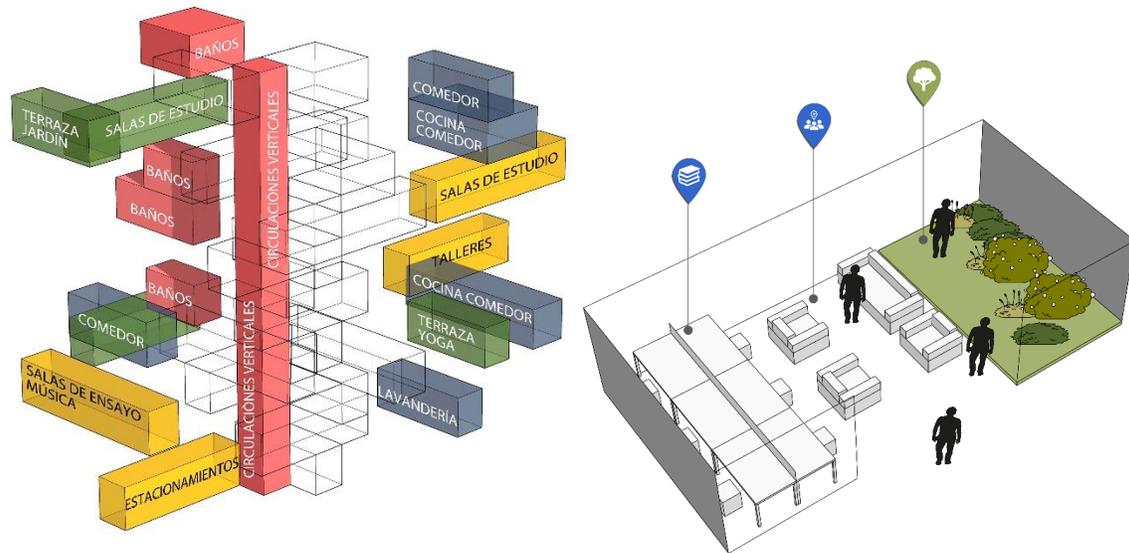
Espacios Colectivos. (Elaboración propia, 2020)
